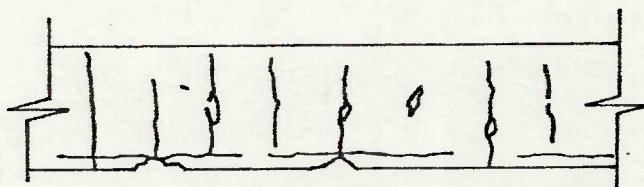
Trincas e lascamentos no concreto provocados pela corrosão da armadura
